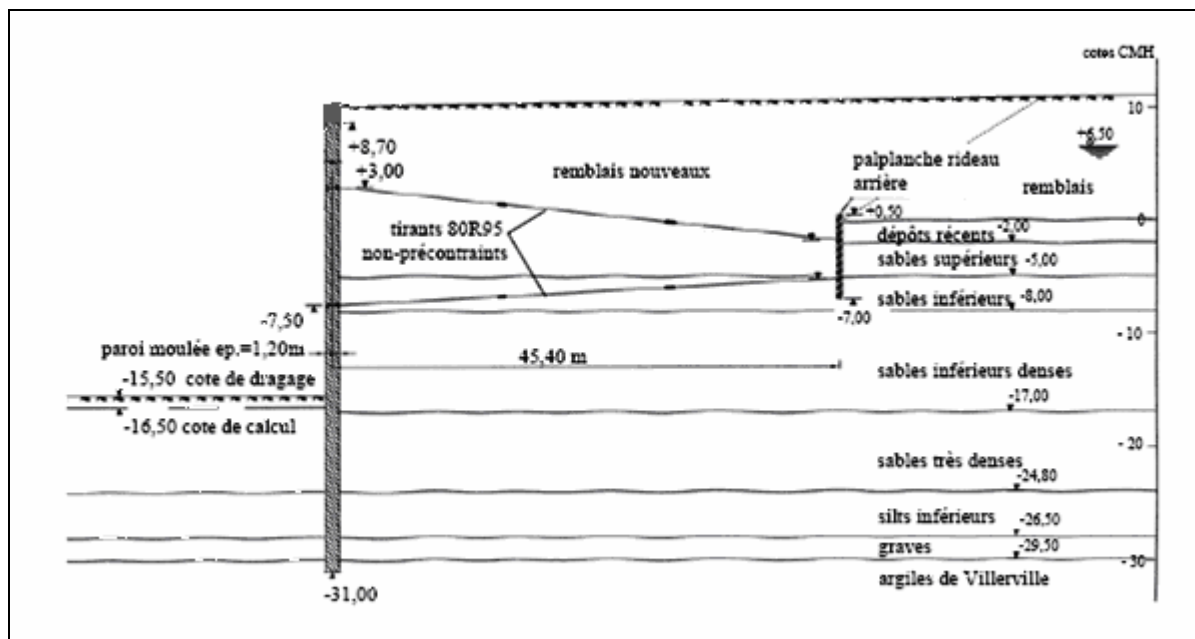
Coupe de la paroi au niveau du panneau instrumenté [23].
